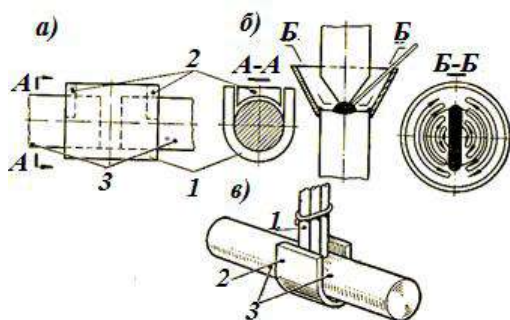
Схема ваннодуговой сварки арматурных стержней
